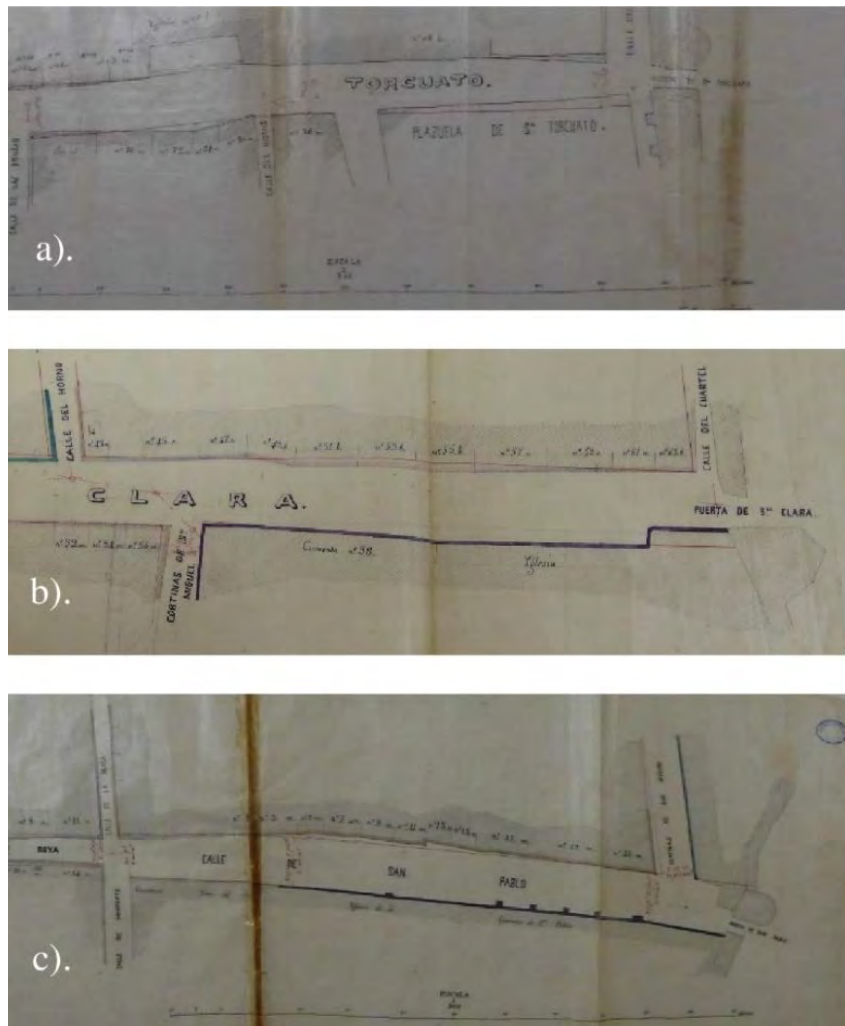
Detalle de las puertas de a). San Torcuato, b). Santa Clara y c). San Pablo, en los planos de alineación de las calles de 1872.
